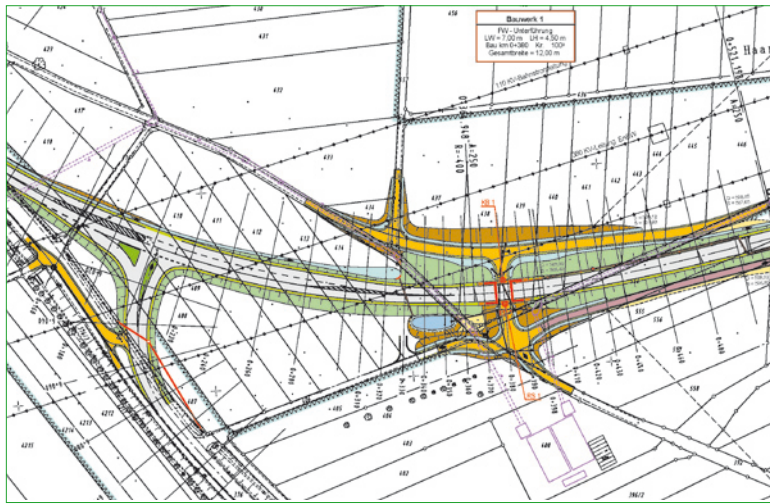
K 1081, Nordumfahrung Herrenberg, Bauentwurf (Ausschnitt)
